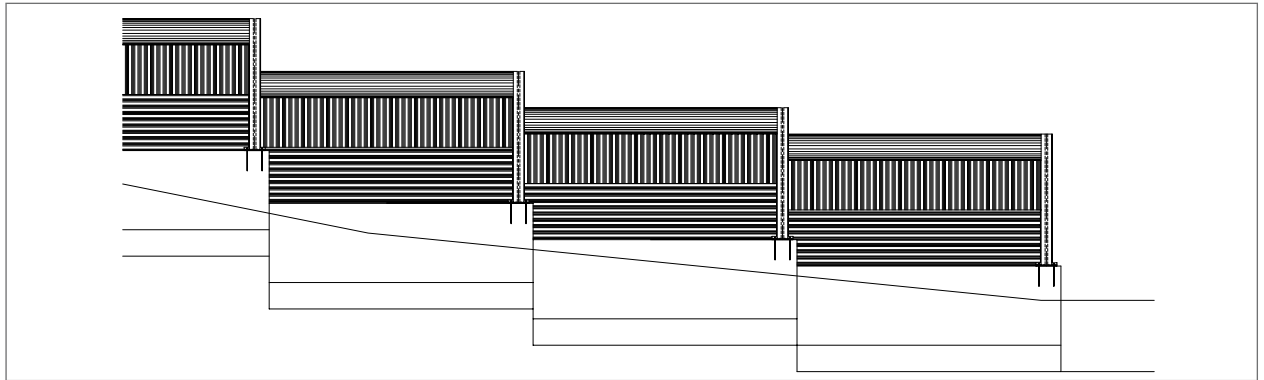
Exemple de semelle superficielle en escalier - Les poteaux sont implantés à proximité de l'extrémité - la forme des panneaux assure la transition entre deux semelles et permet l'étanchéité acoustique
